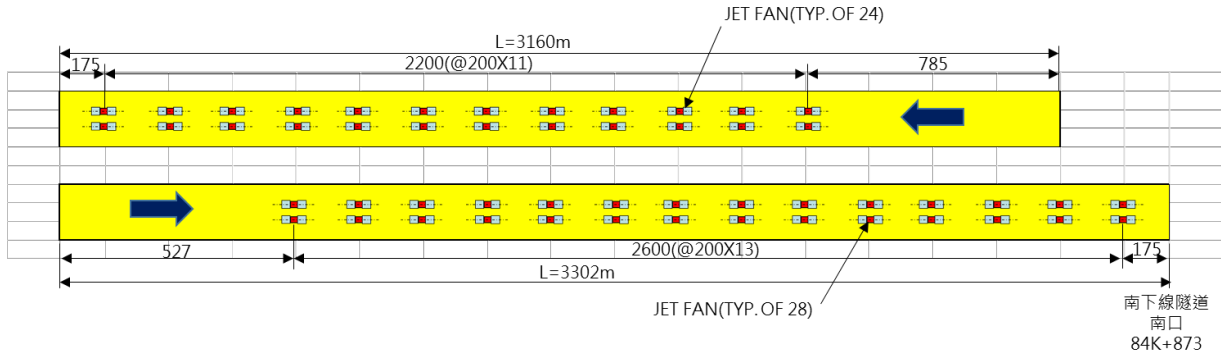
隧道噴流式風機 (JET FAN) 設備配置平面示意圖
